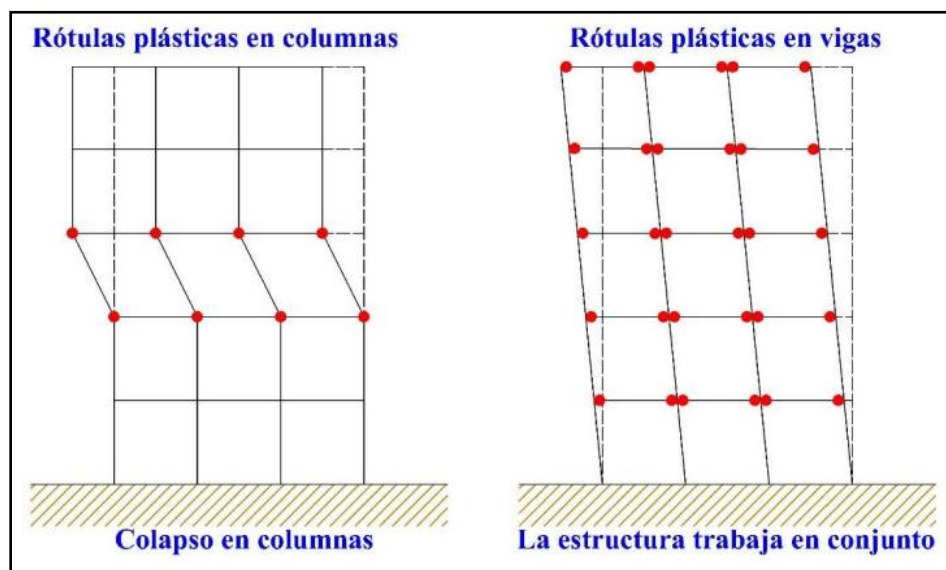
Mecanismo de falla en Columnas y en vigas. (Smith 2020)
